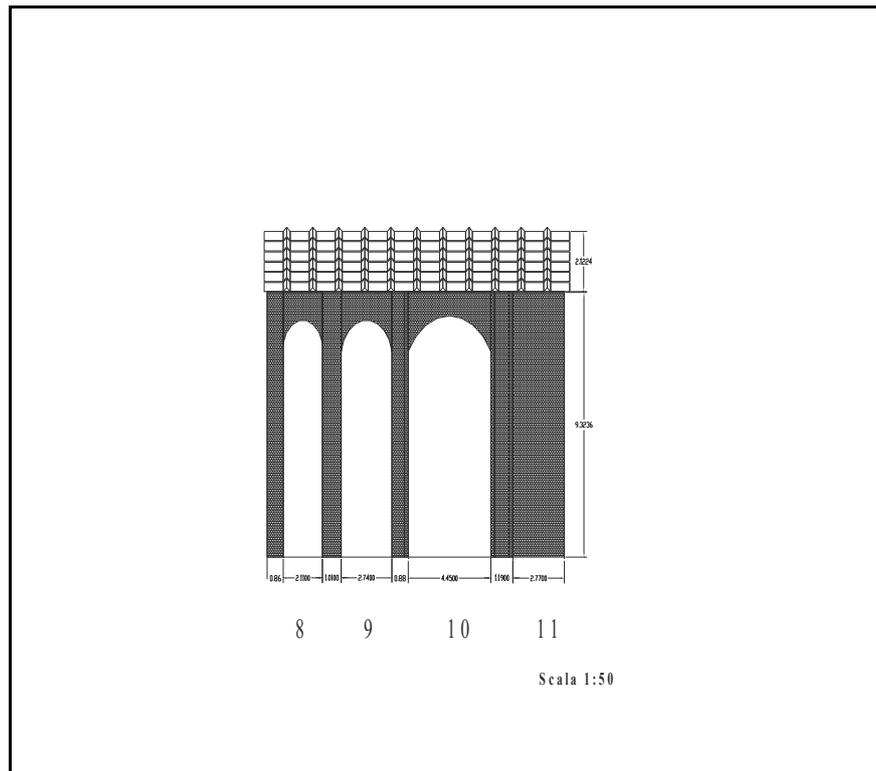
Prospetto ricostruttivo muro nord, lato via Appia (secondo l'ipotesi B)
